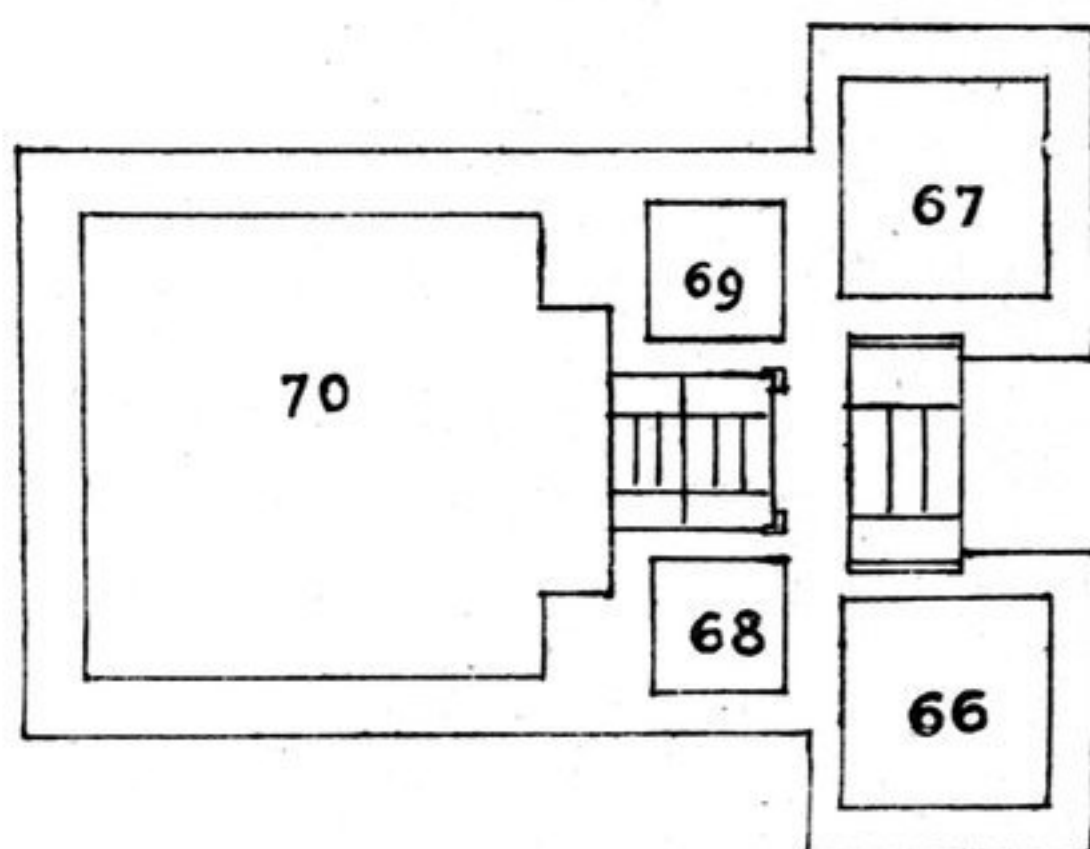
Plan du groupe de st. B, 66 à B, 70.
